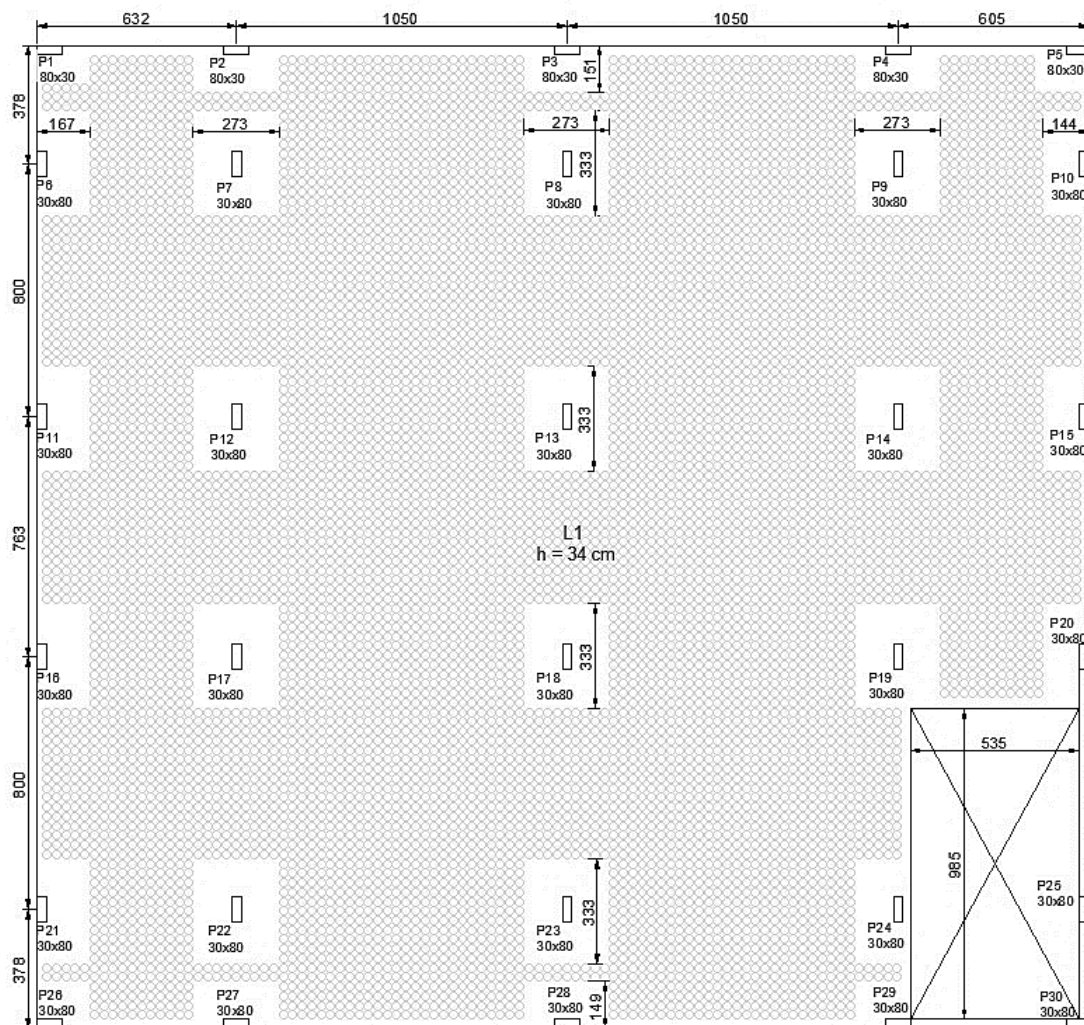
Projeto B3 - Planta de forma (dimensões em cm).
